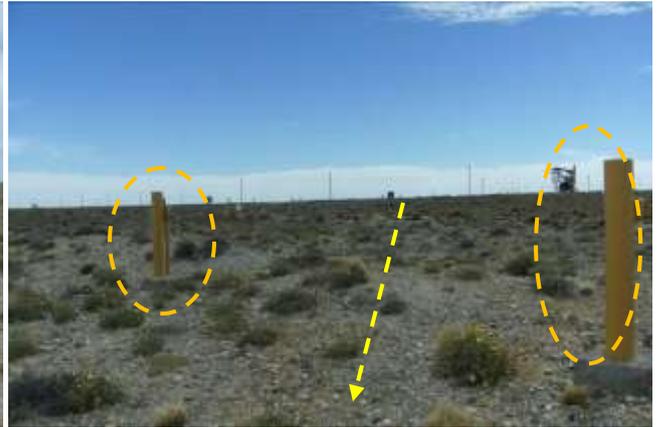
Emplazamiento de gasoducto por picada existente. Se observa protección catódica (anaranjado). Foto en dirección O.
